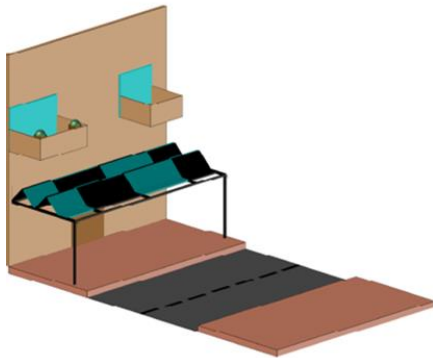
Sistema de apantallamiento acústico en fase de plegado
